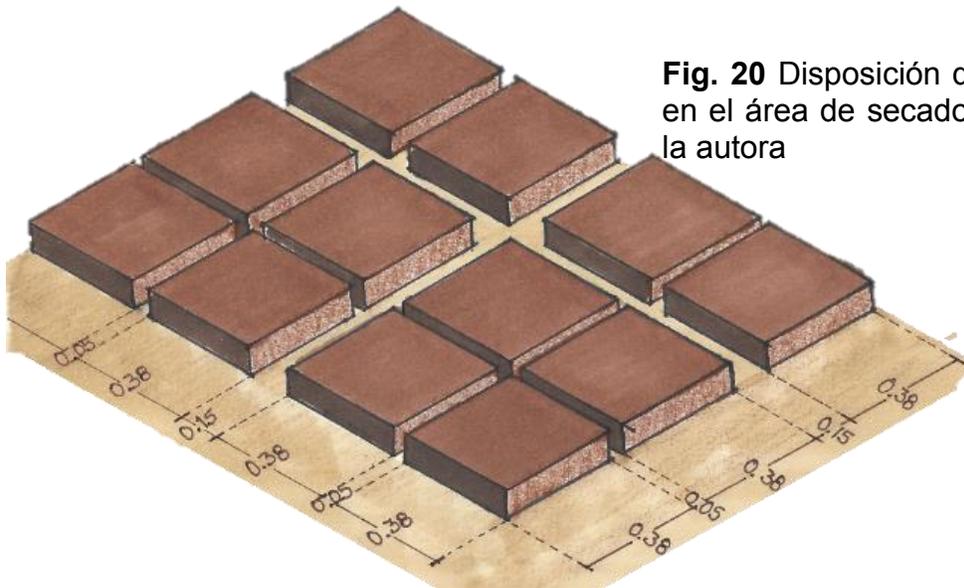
Disposición de los adobes en el área de secado. Imagen: De la autora
